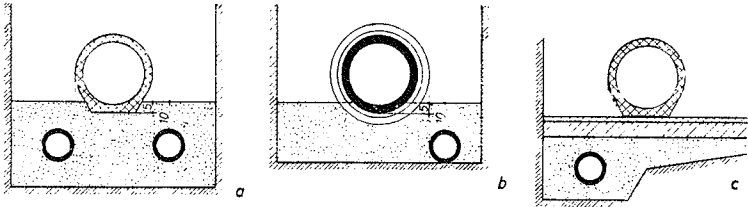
Dränung der Baugruben bei Kanalisation [7.14], a mit zwei Dränrohren ohne Betonsohle, b mit einem Dränrohr ohne Betonsohle, c mit Betonsohle
